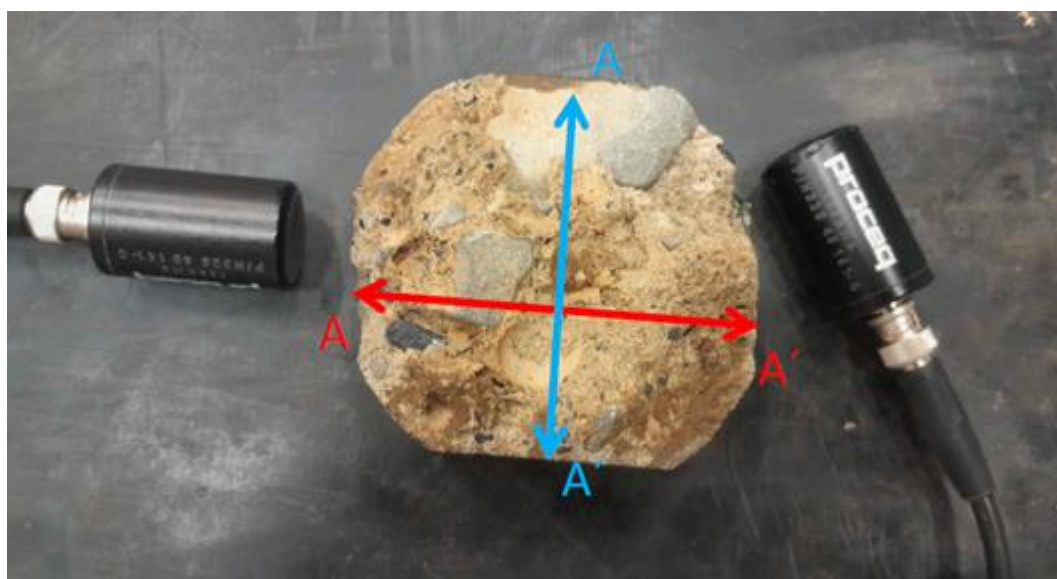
a 8 Jádrový odvrt – soudržná část a nesoudržný podsyp dřevěné dlažby
